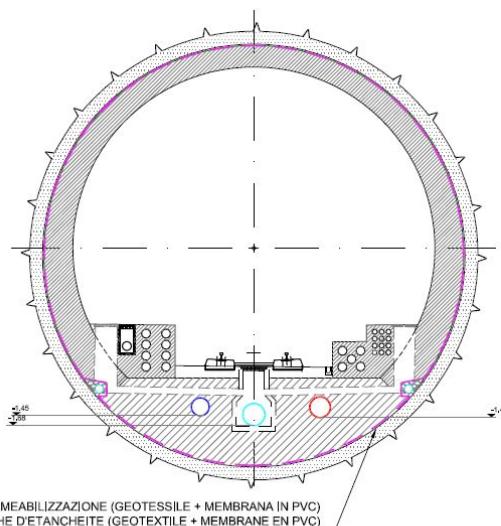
Impermeabilizzazione di tipo 5/5a per scavo con TBM aperta
